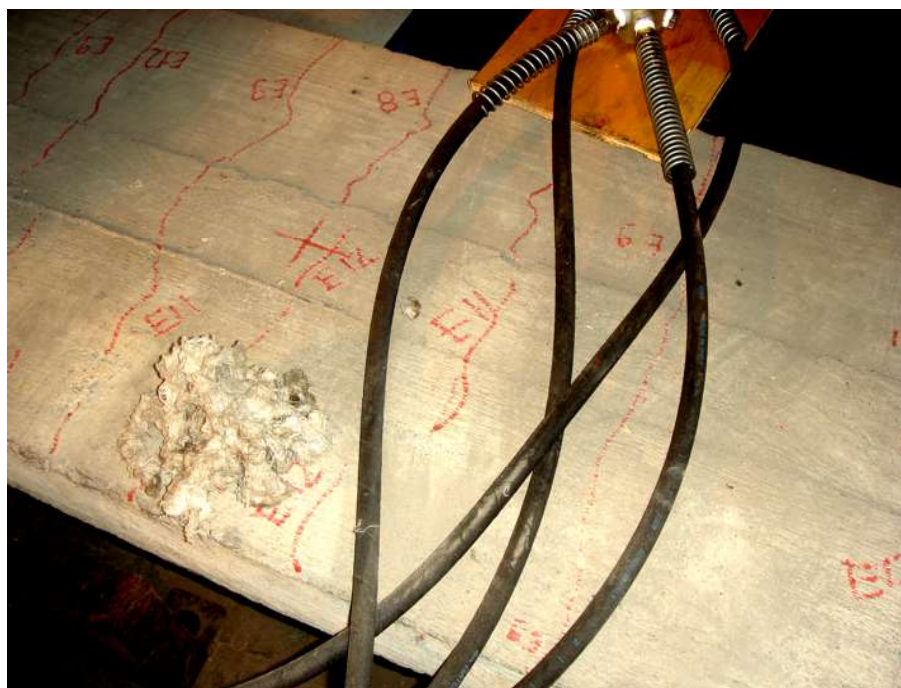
Fissuras de flexão na laje do protótipo U2-P
